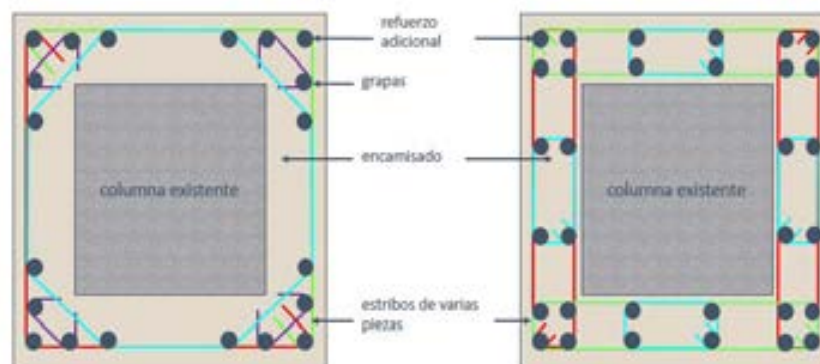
Posibles configuraciones de encamisado de columnas con concreto (Terán A., 2009)
